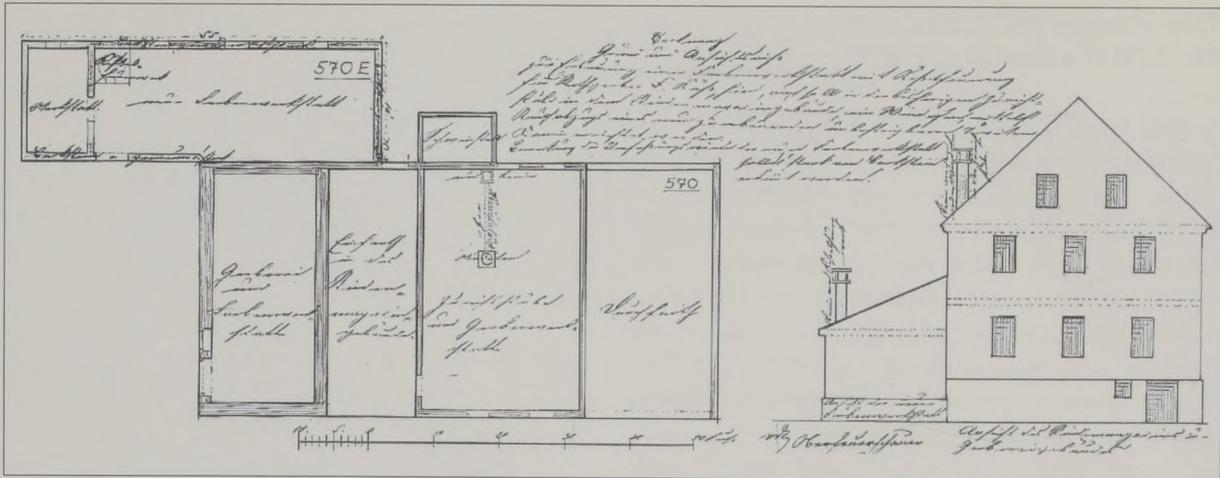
Grundriss und Ansicht der Scheuer 570 mit der geplanten Farbenwerkstatt, die allerdings zweigeschossig ausgeführt wurde.
